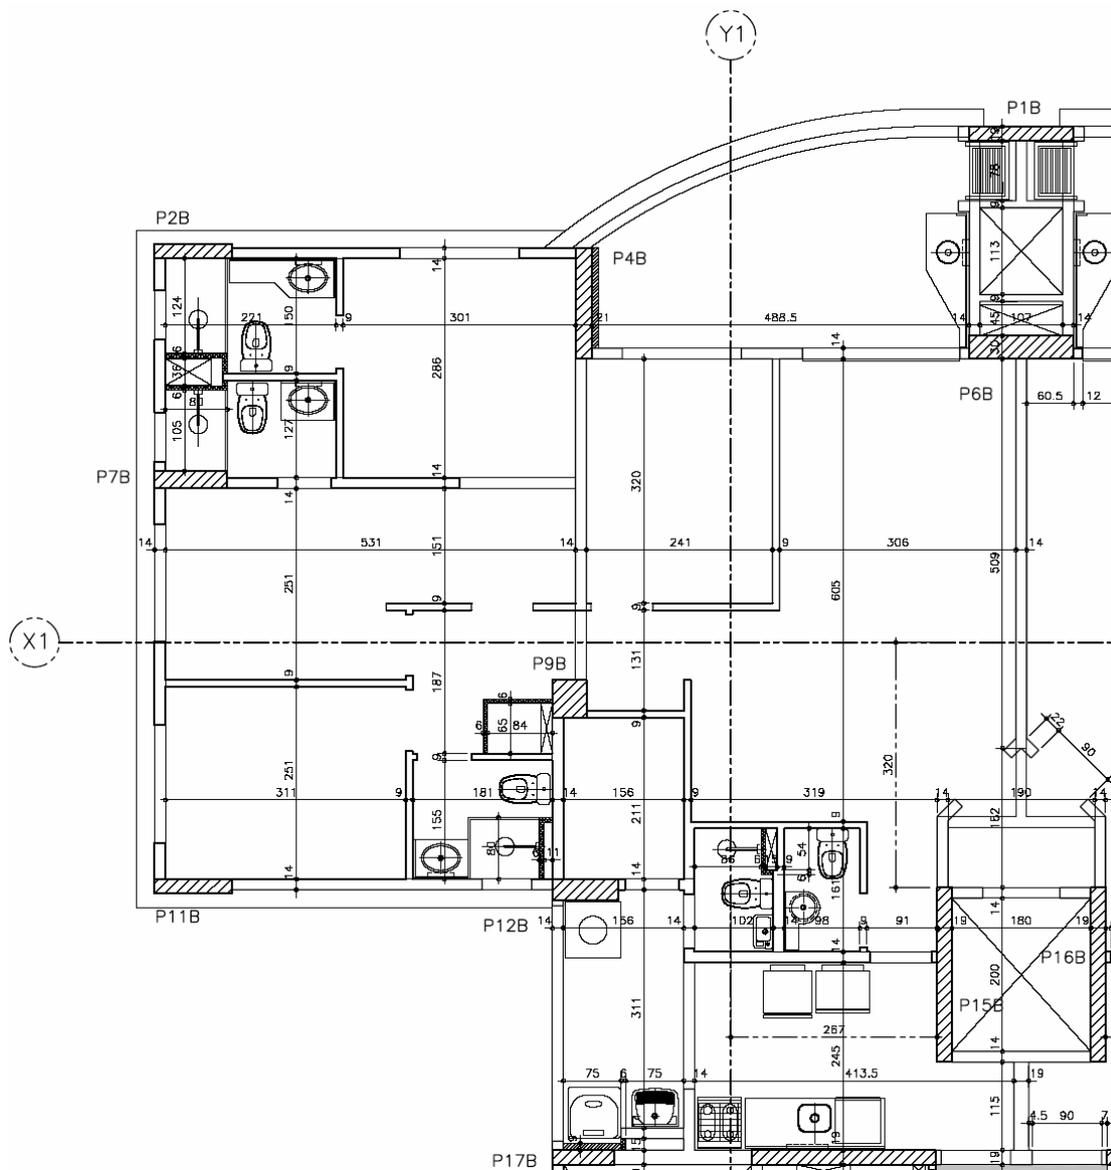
Planta original do apartamento - Estudo de Caso A
